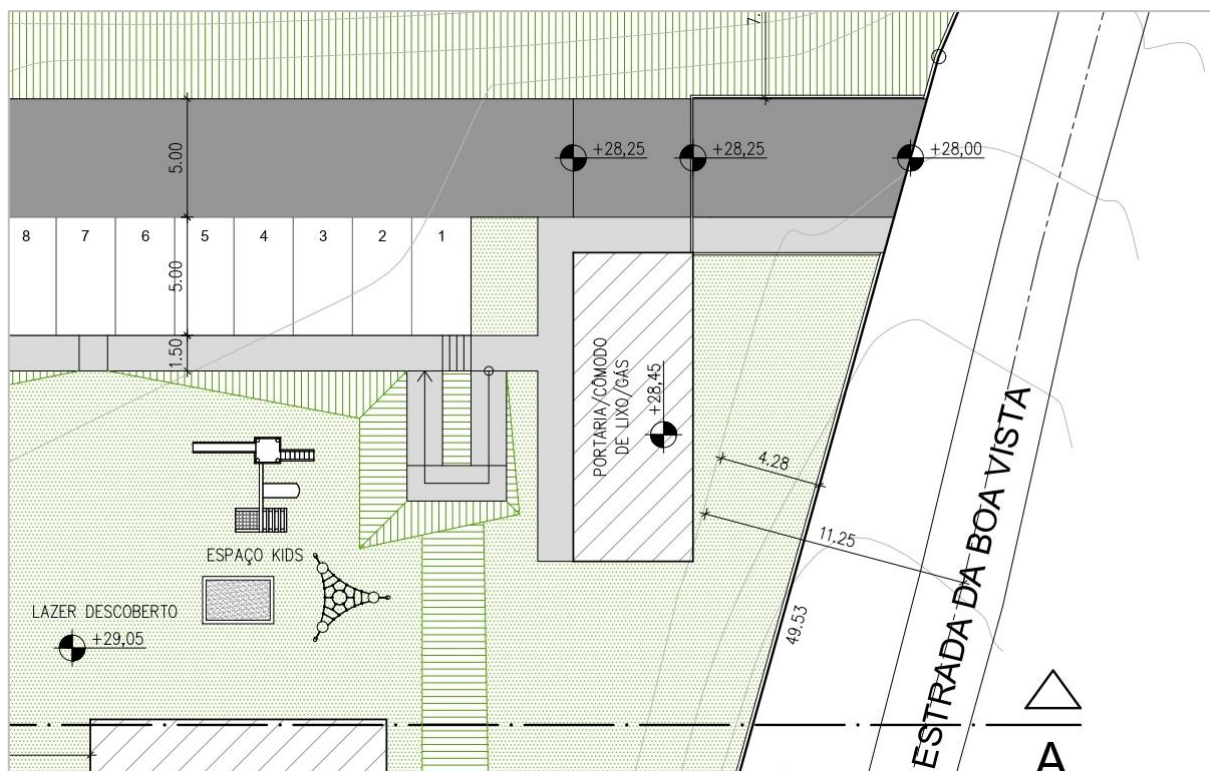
Recorte planta de implantação evidenciando a portaria (Residencial Boa Vista 1).
